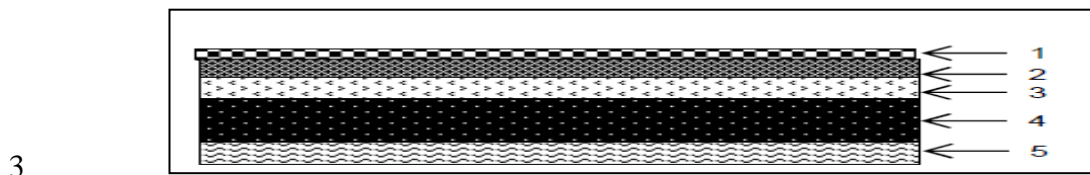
Coupe verticale d'un plancher étage courant à dalle pleine.
